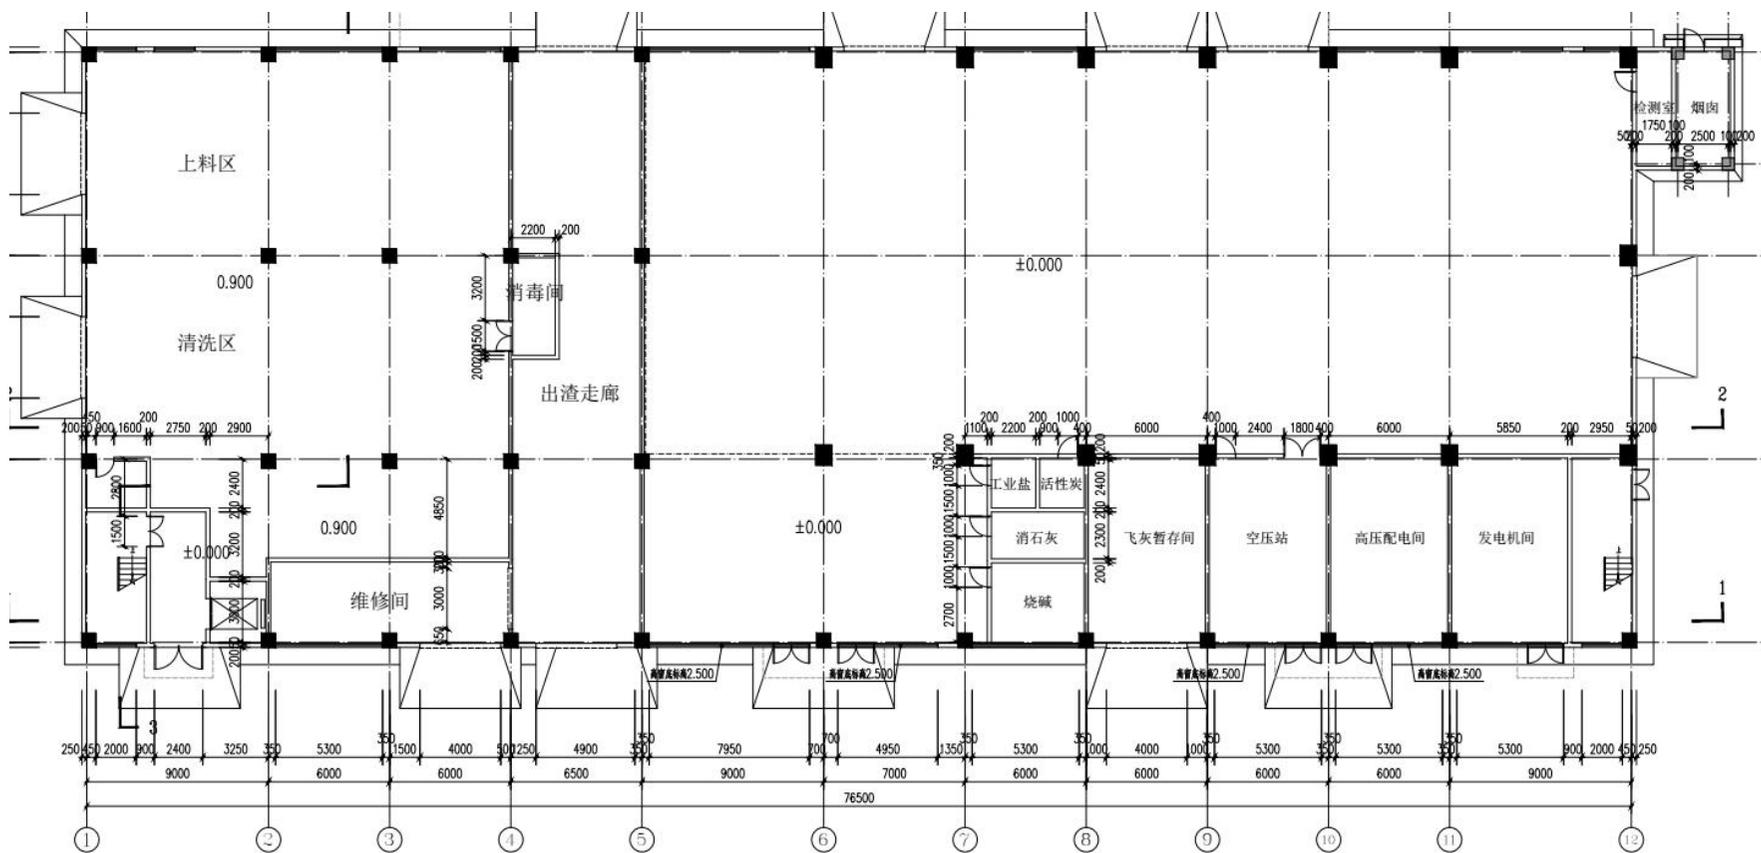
项目主厂房一层平面布置图 (1:150)
